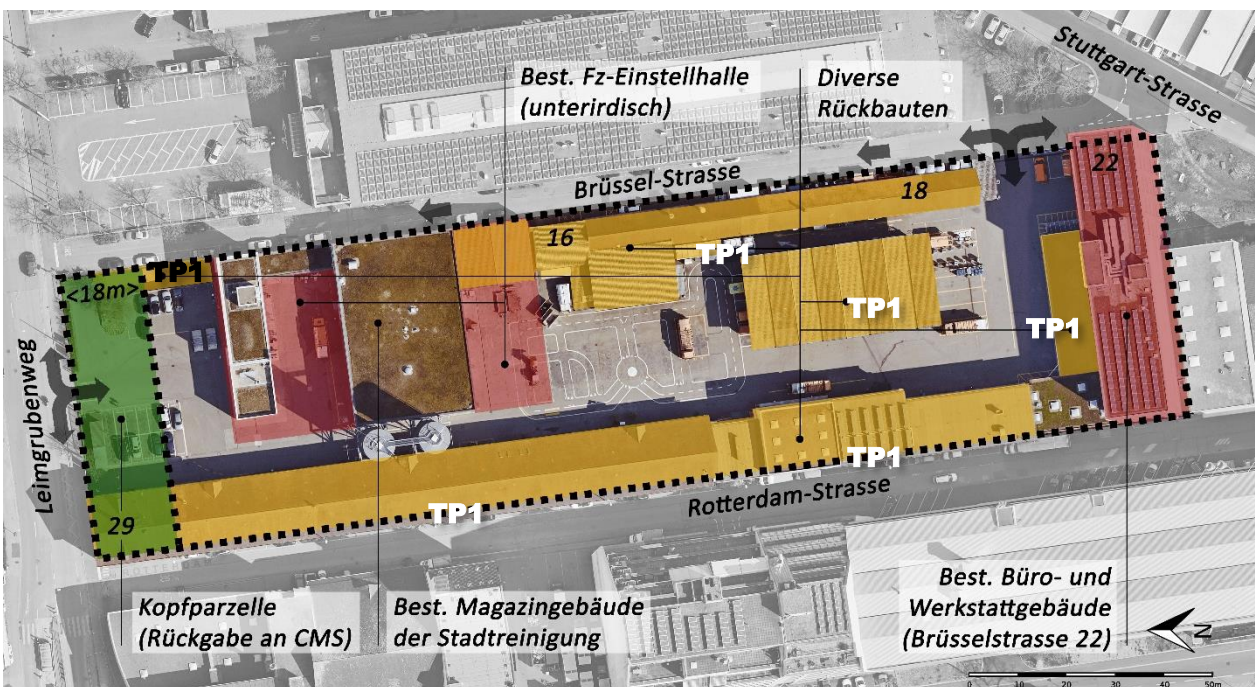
Geplante Rückbauten (gelb) innerhalb des Bearbeitungs- und Bauperimeters
